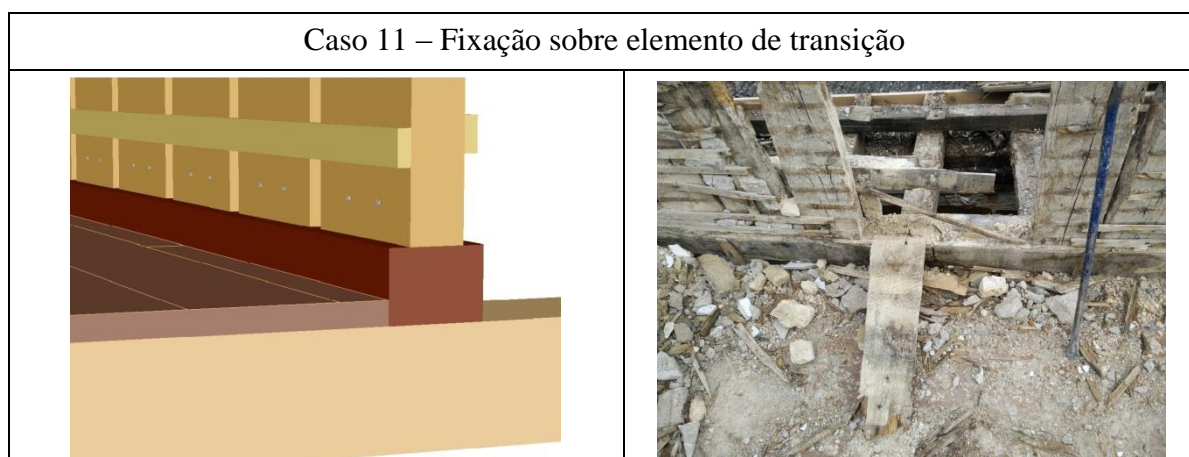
Ligações inferiores de tabique a vigas ou outros elementos - Caso 11
